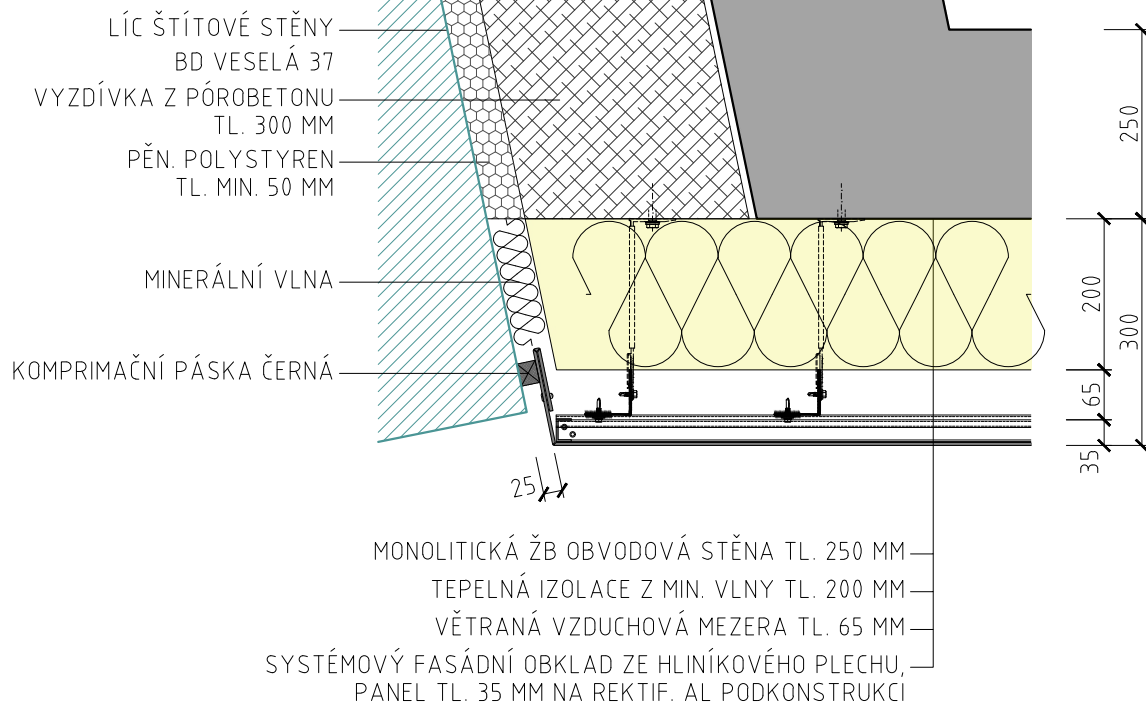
DETAILY STAV. NAPOJENÍ K SOUSEDNÍM OBJEKTŮM
